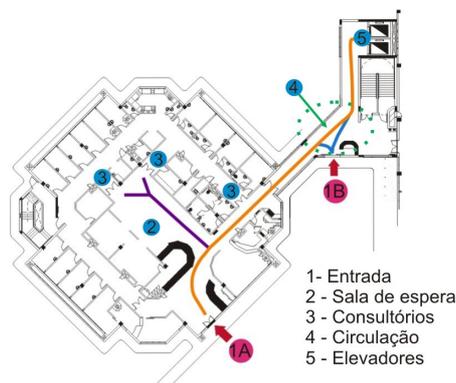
Pavimento 1 – rotas referentes ao sistema de consulta
